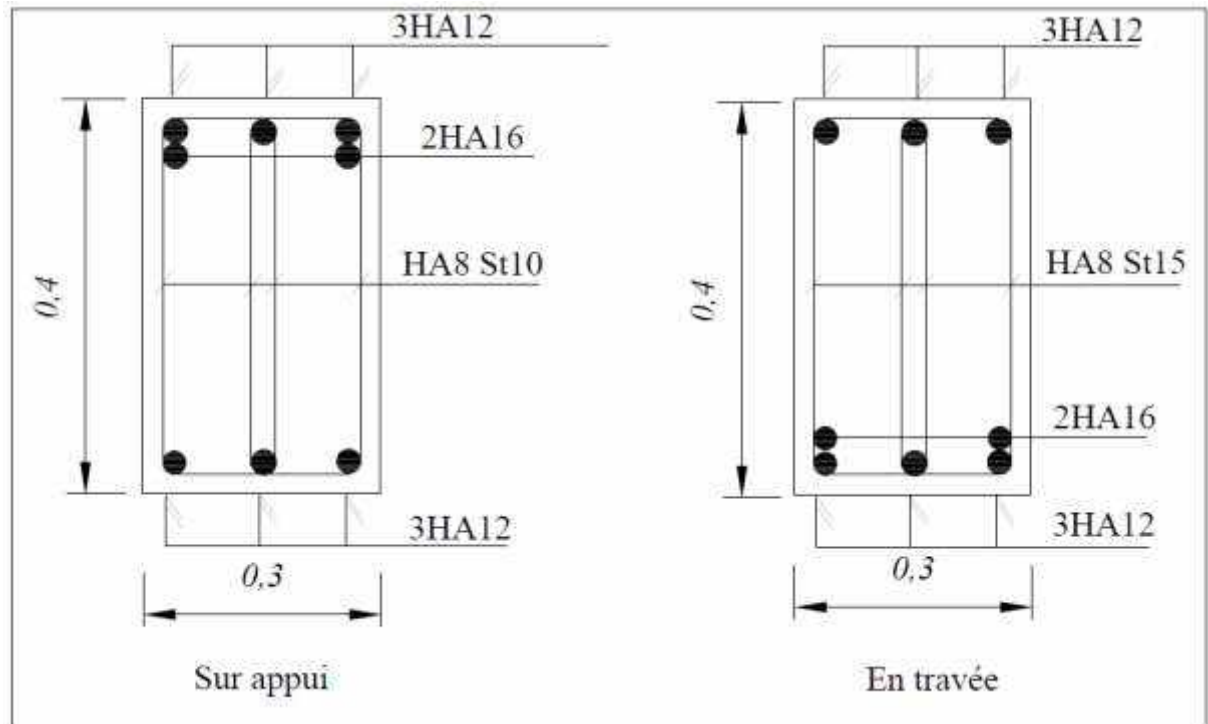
Schéma de ferrailage des poutres secondaires.
